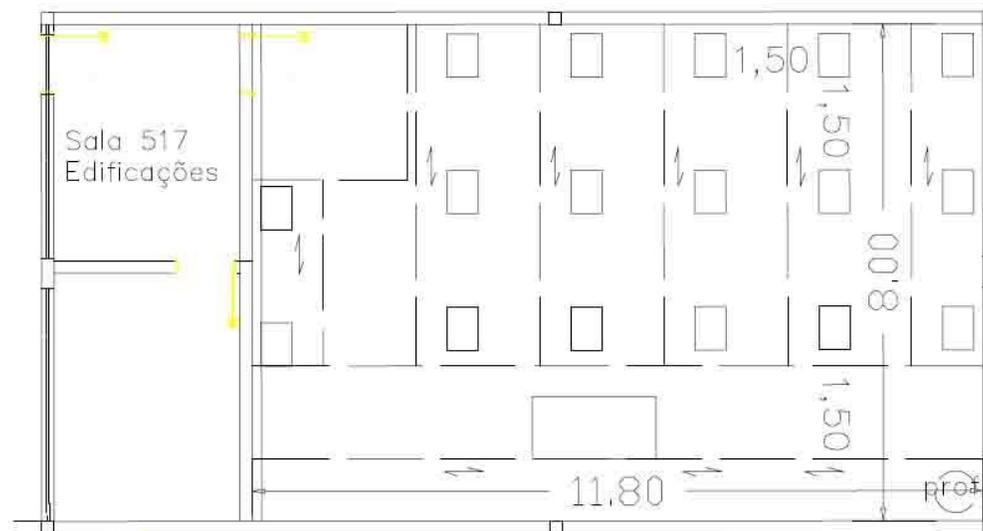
Planta baixa sala 517 - bloco Edificações - Cenário 1
